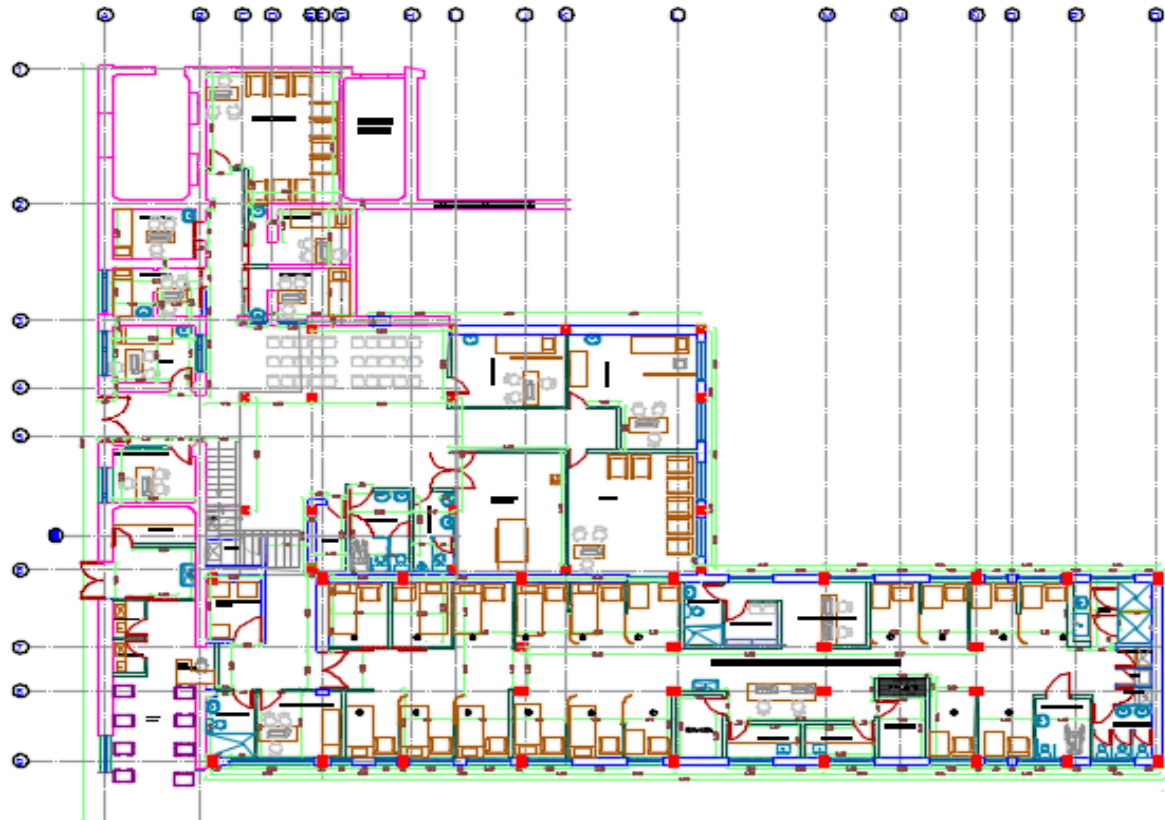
Propuesta arquitectónica del pabellón de pediatría. Fuente: Autor
